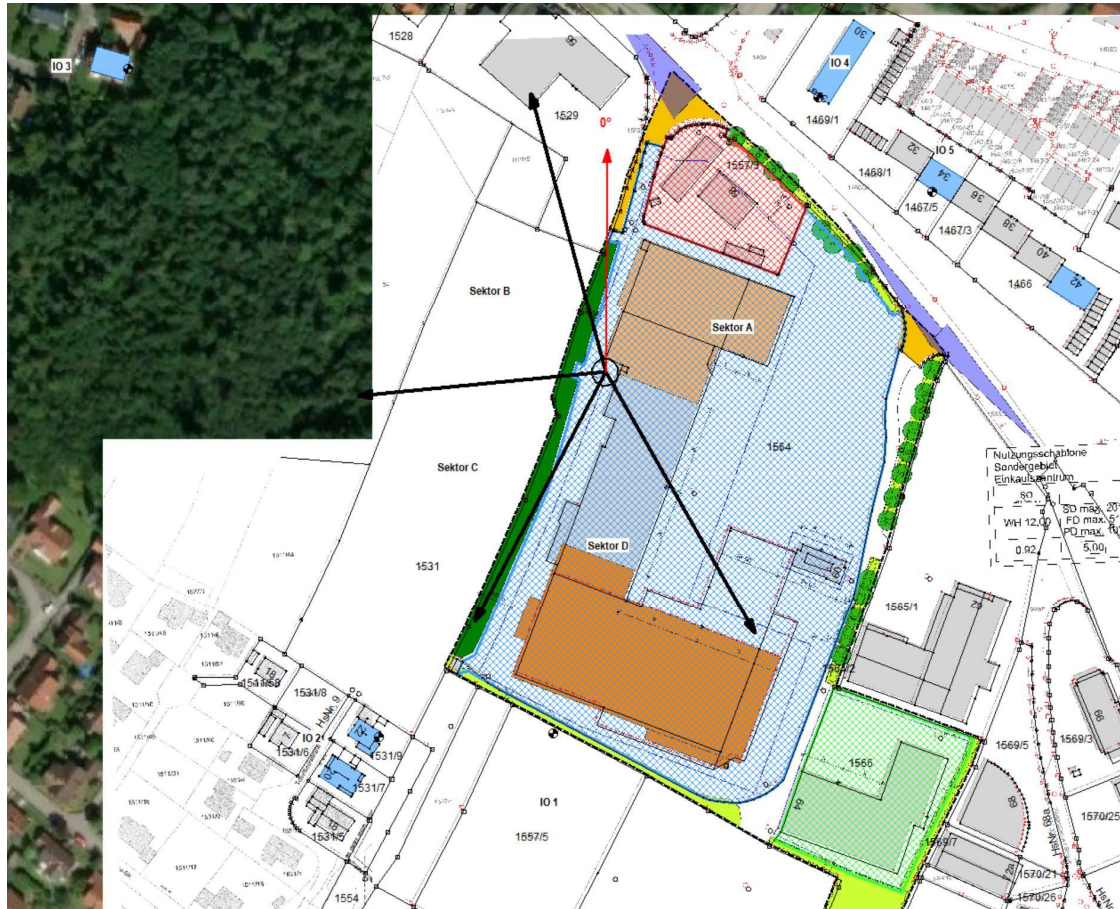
Lageplan mit Kennzeichnung der Immissionsorte IO 1 – IO 5
